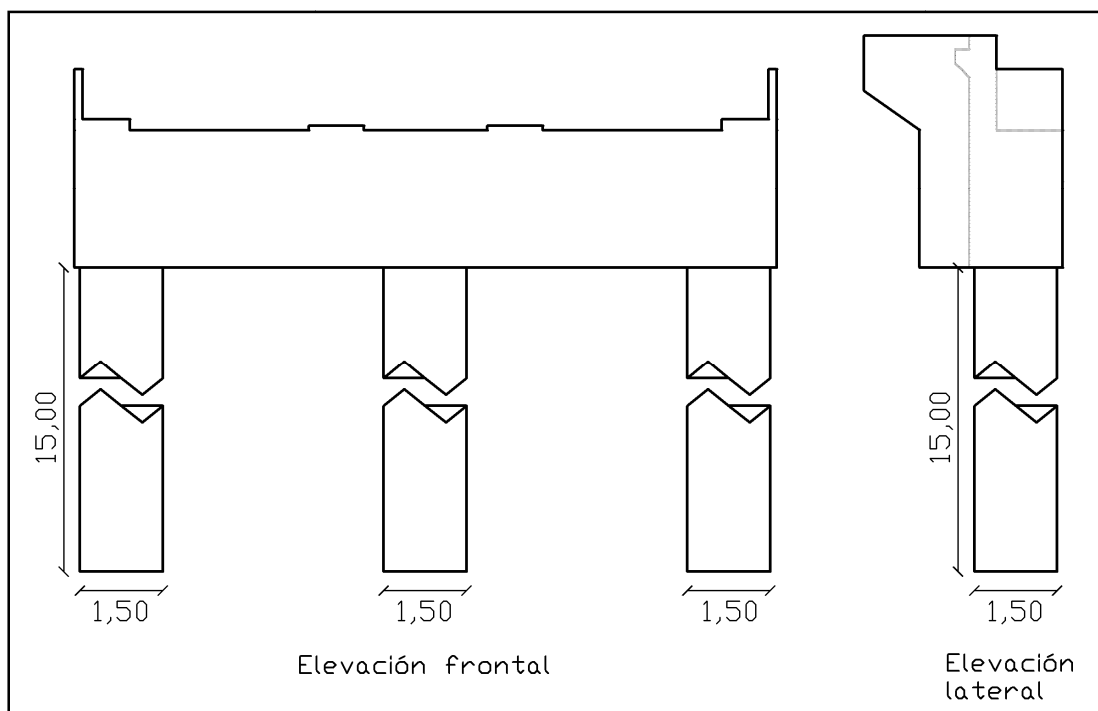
fundaciones profundas en estribo (dimensiones en m)
